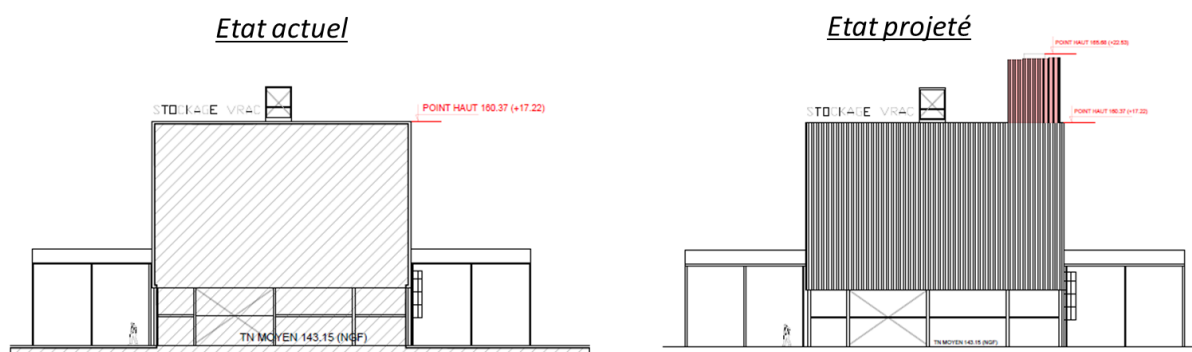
Plan de coupe avant et après l'installation de l'extension de chargement en vrac des prémix (source : Permis de construire)
